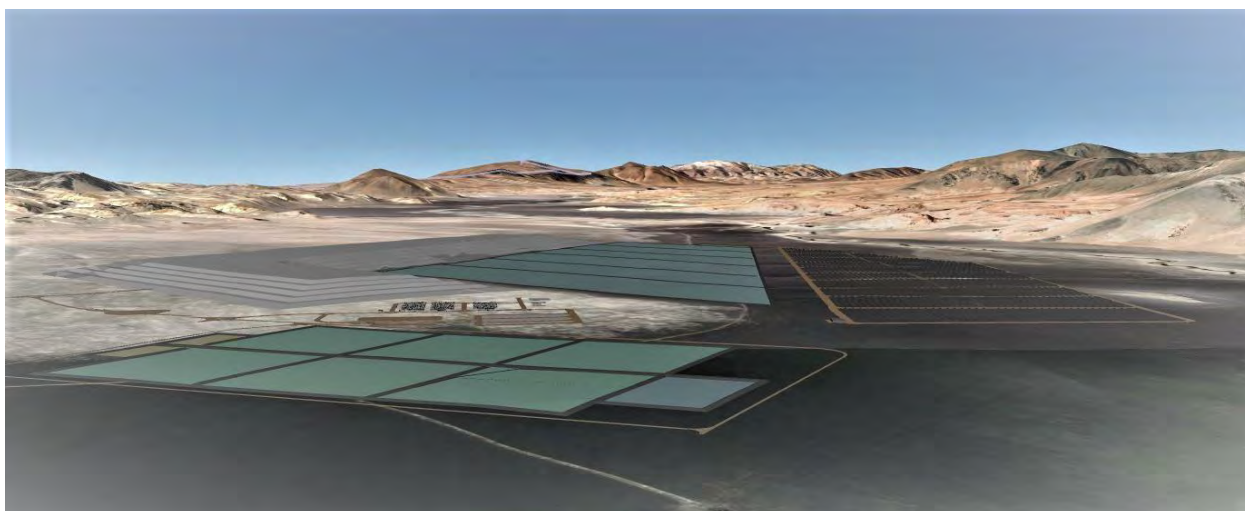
Vista de norte a sur de las piletas de evaporación, planta de procesamiento y de los acopios de sales de cosecha.
